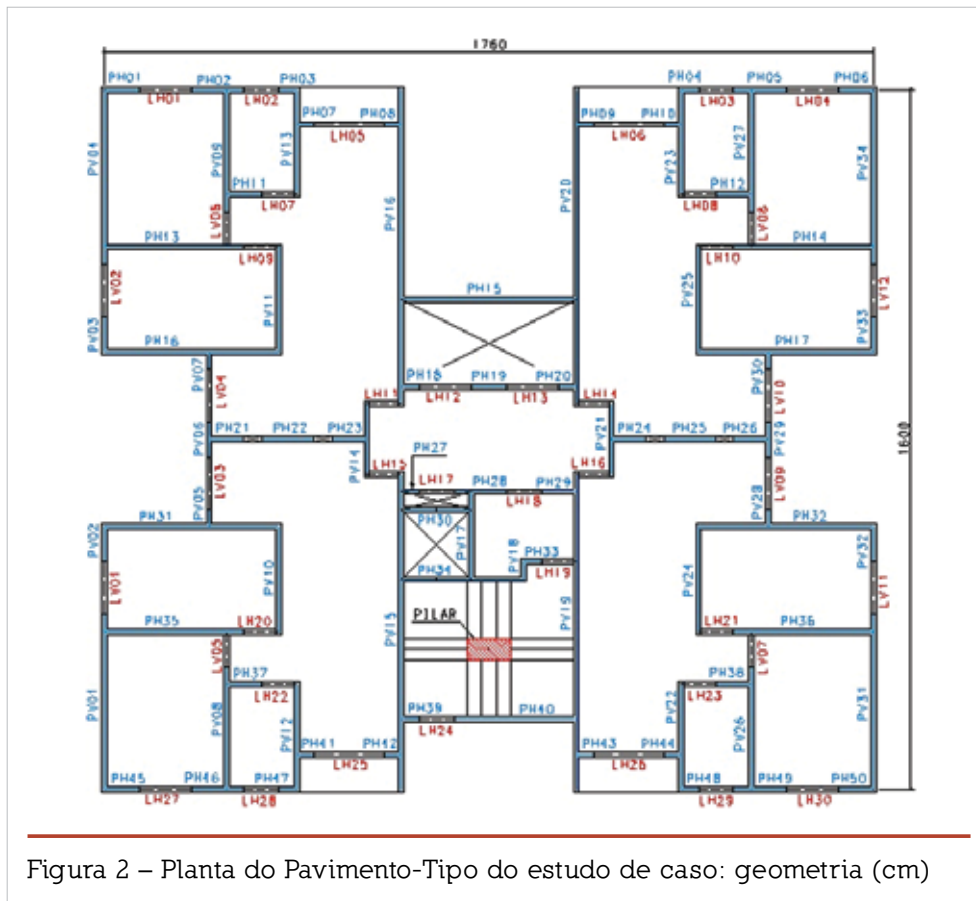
Planta do Pavimento-Tipo do estudo de caso: geometria (cm)
